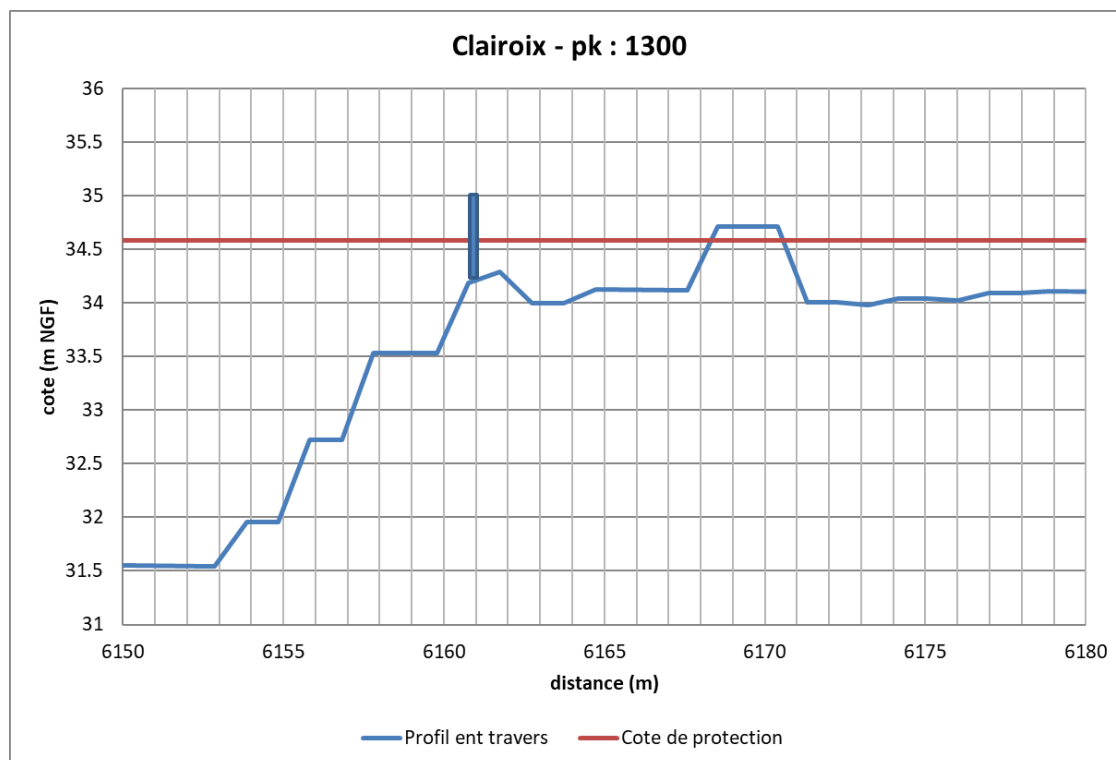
Profil en travers du tronçon 4 du système d'endiguement de Clairoix (muret en béton en aval)
